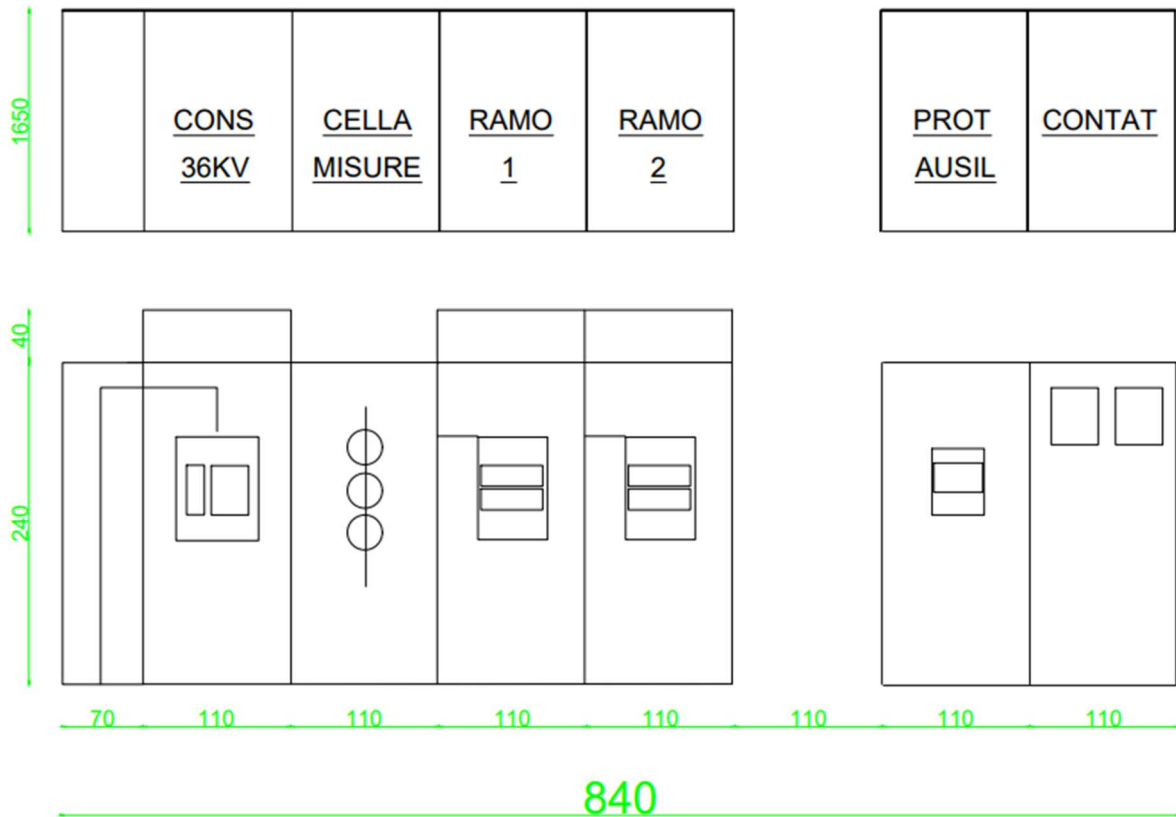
Viste planimetriche e in prospetto della cabina di smistamento
